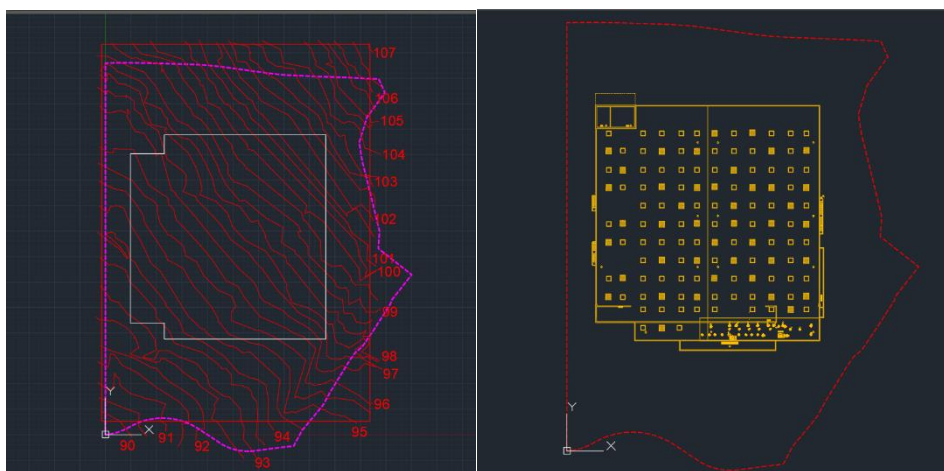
Planta de implantação e planta de cobertura do *Leroy Merlin* de Loulé
